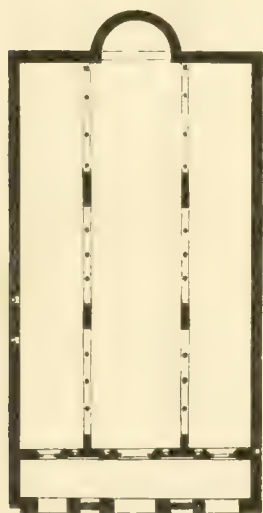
Grundriss der alten Peterskirche zu Rom
